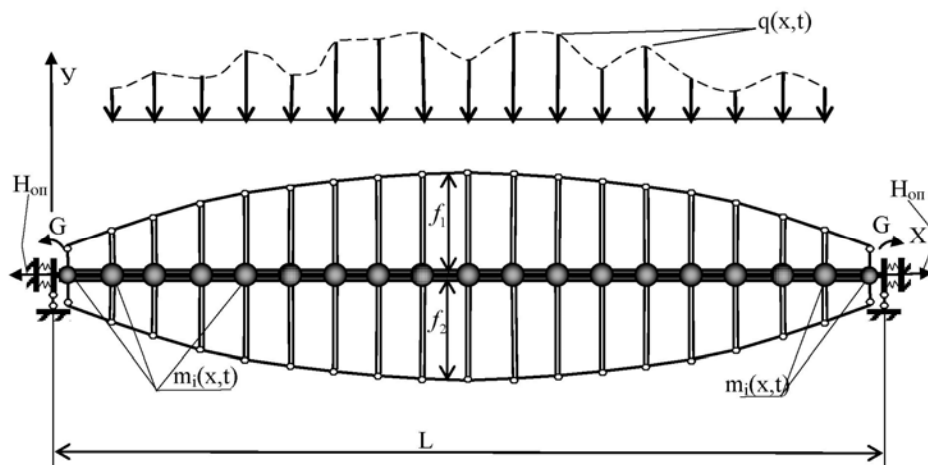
Расчетная схема двухпоясной шпренгельной балки
